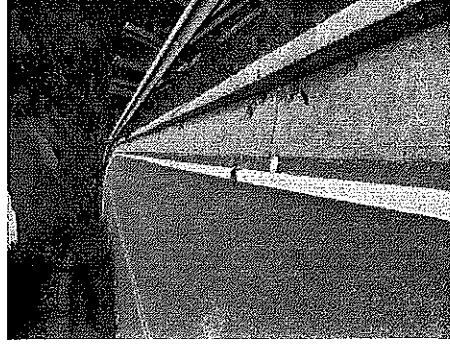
y 2 Estructura tricho metálico (Imagen tomada informe administrador vial)
